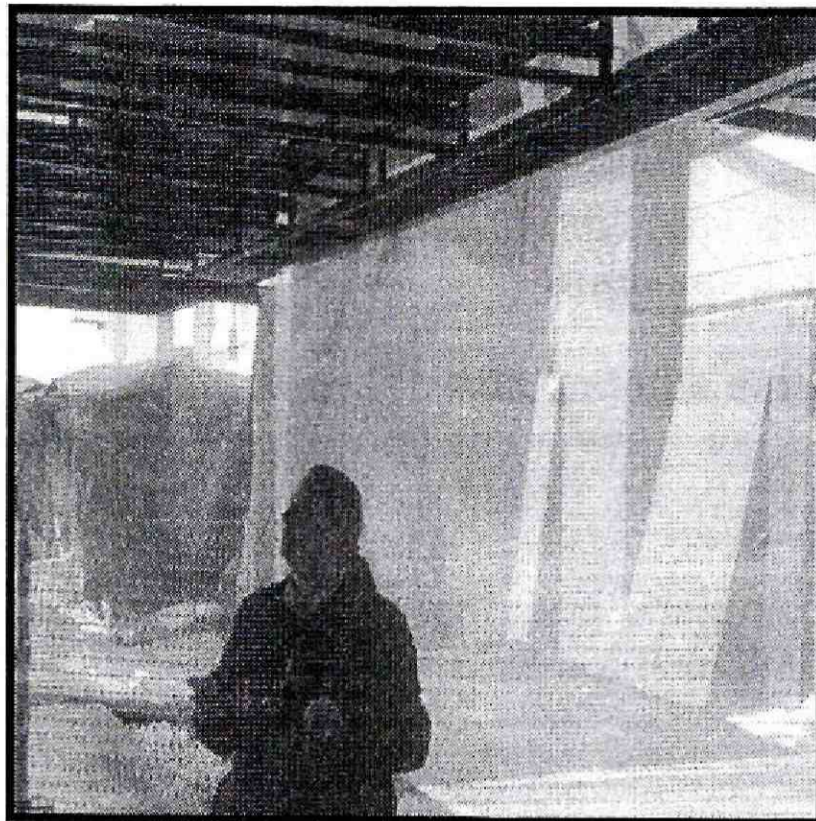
Detalle del refuerzo diseñado para el recalce de las placas en los sectores de los ductos cubiertos por la mampostería
